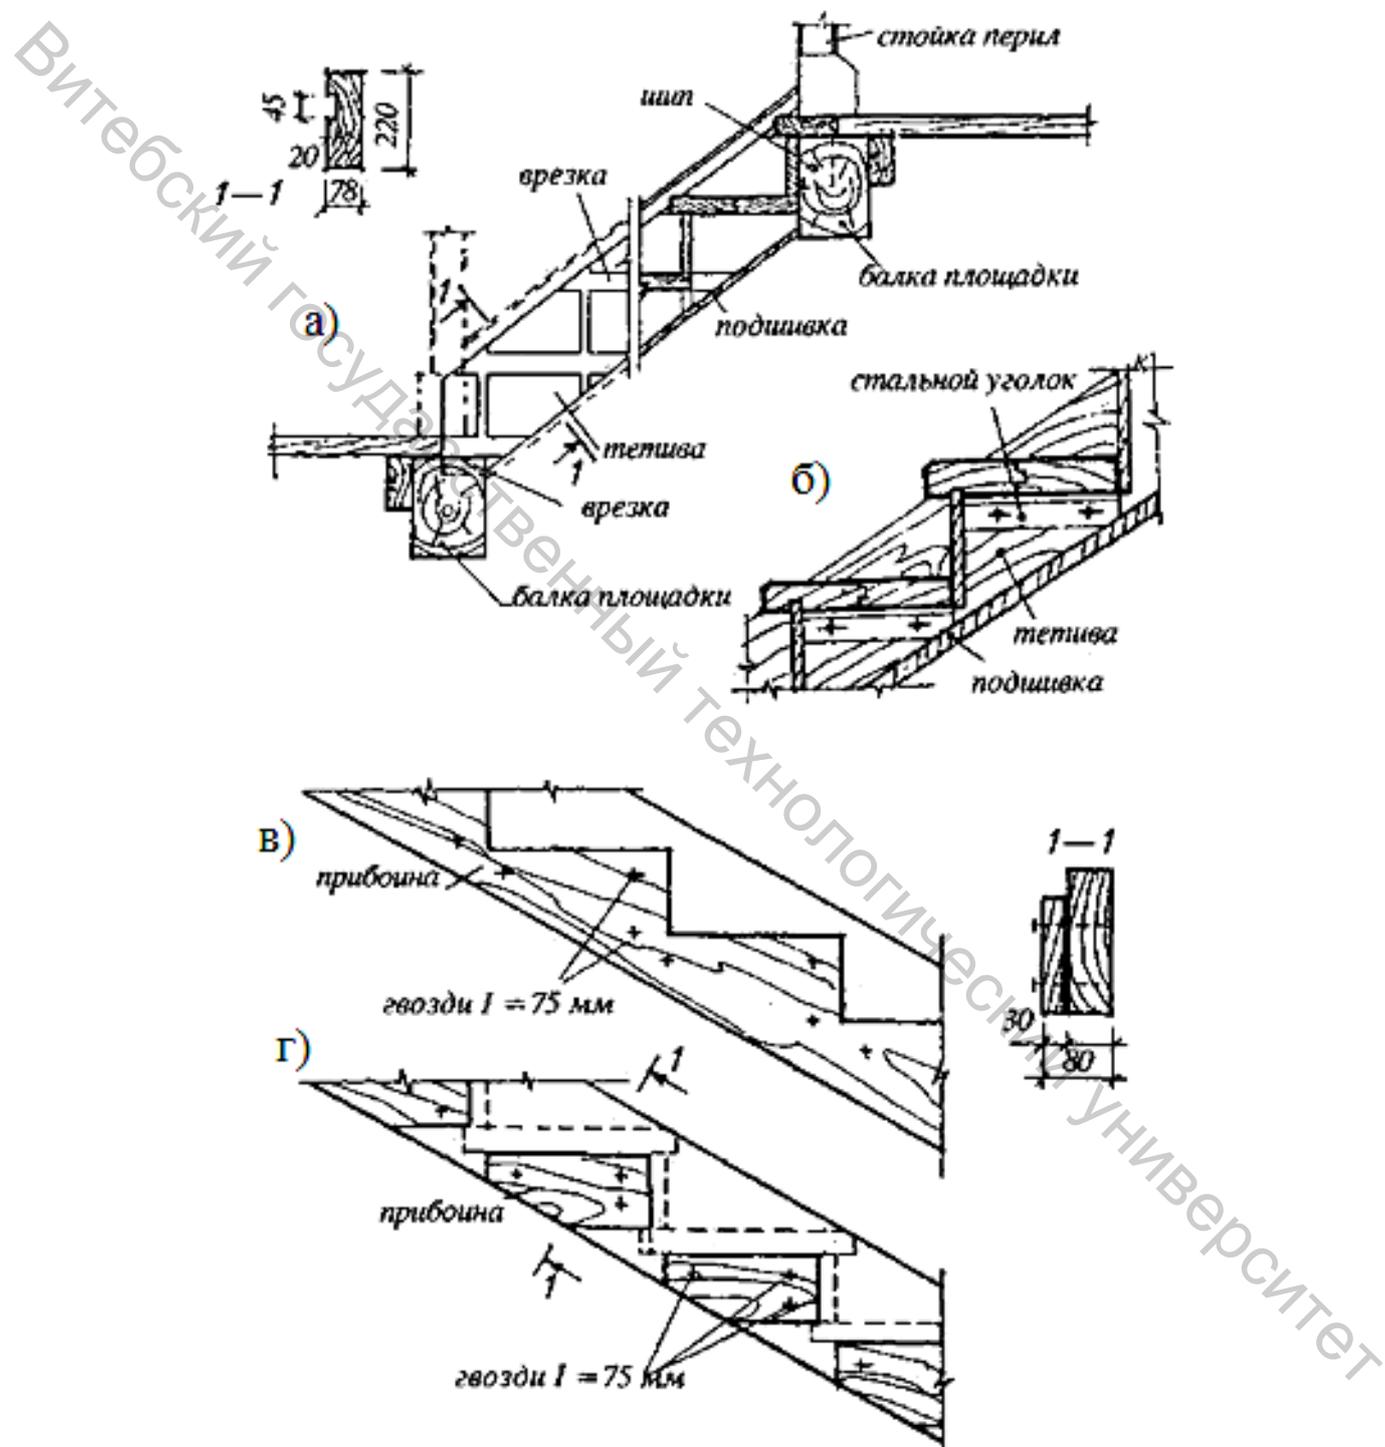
Конструкции деревянных лестниц на тетивах:
